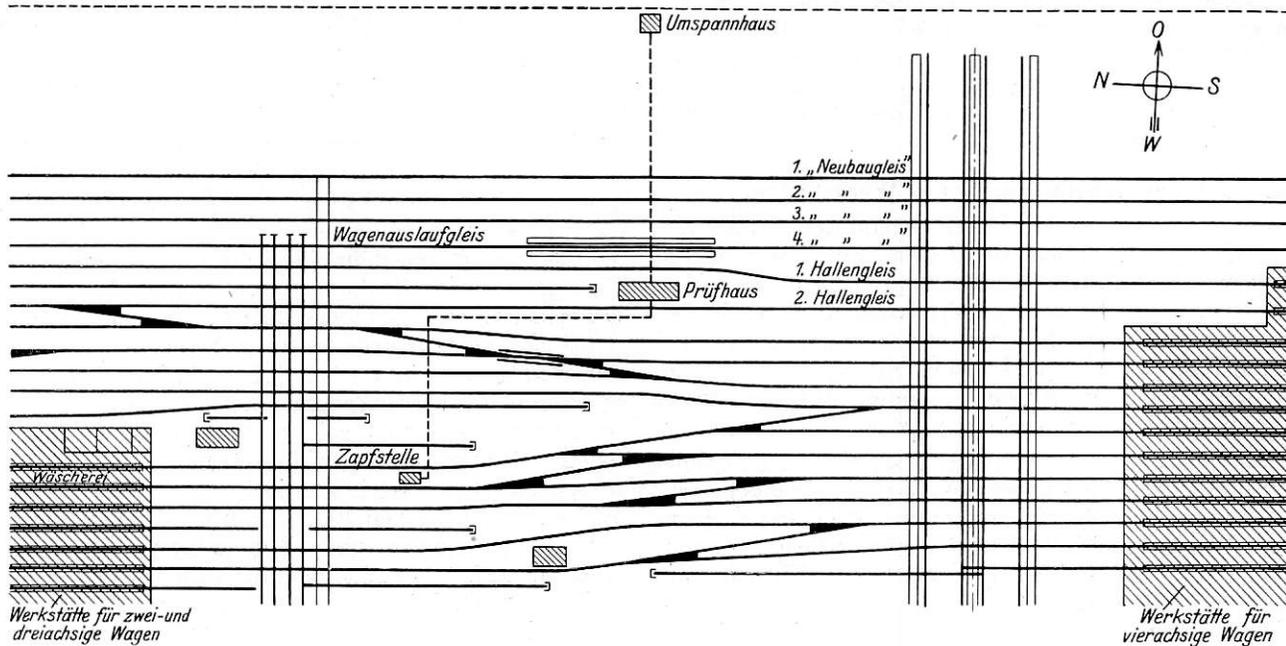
Lageplan der elektrischen Zugheizungs-Prüfanlage.
